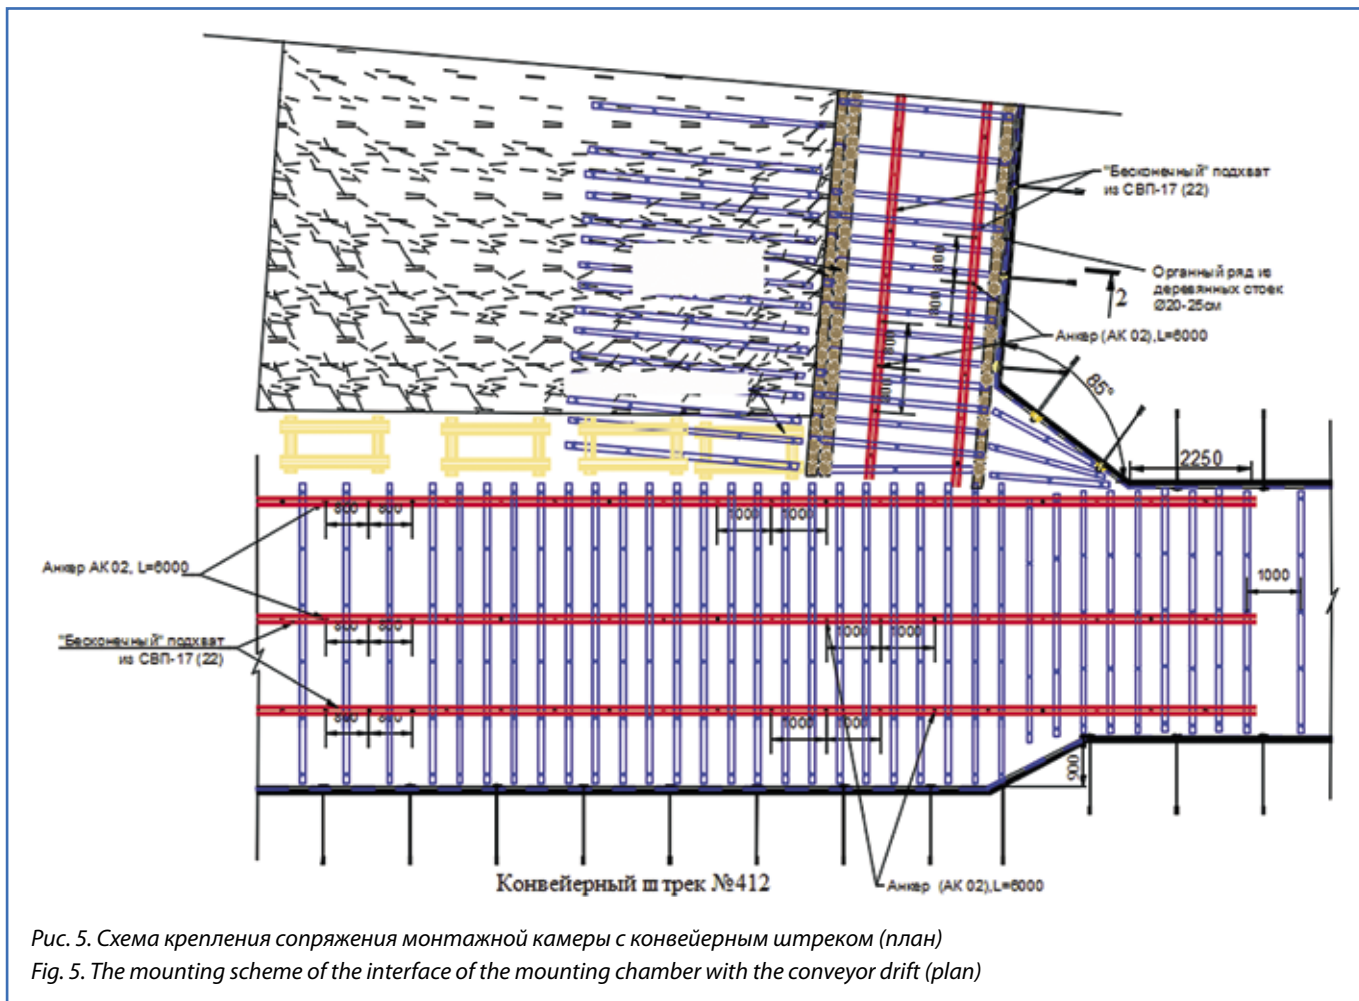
Схема крепления сопряжения монтажной камеры с конвейерным штрехом (план)
